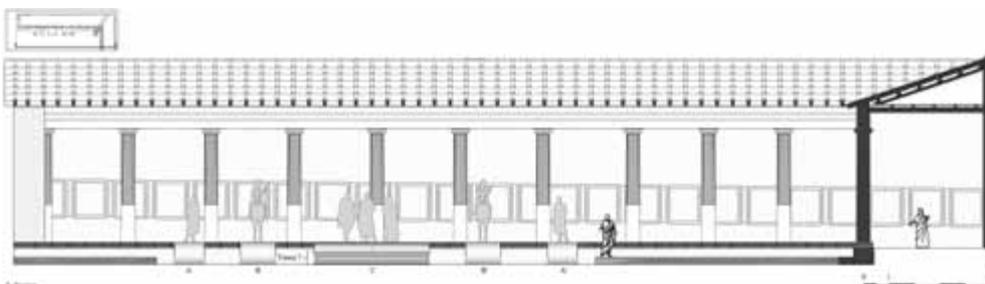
Prospetto ricostruttivo della struttura I e del portico colonnato (scala 1 : 300)
